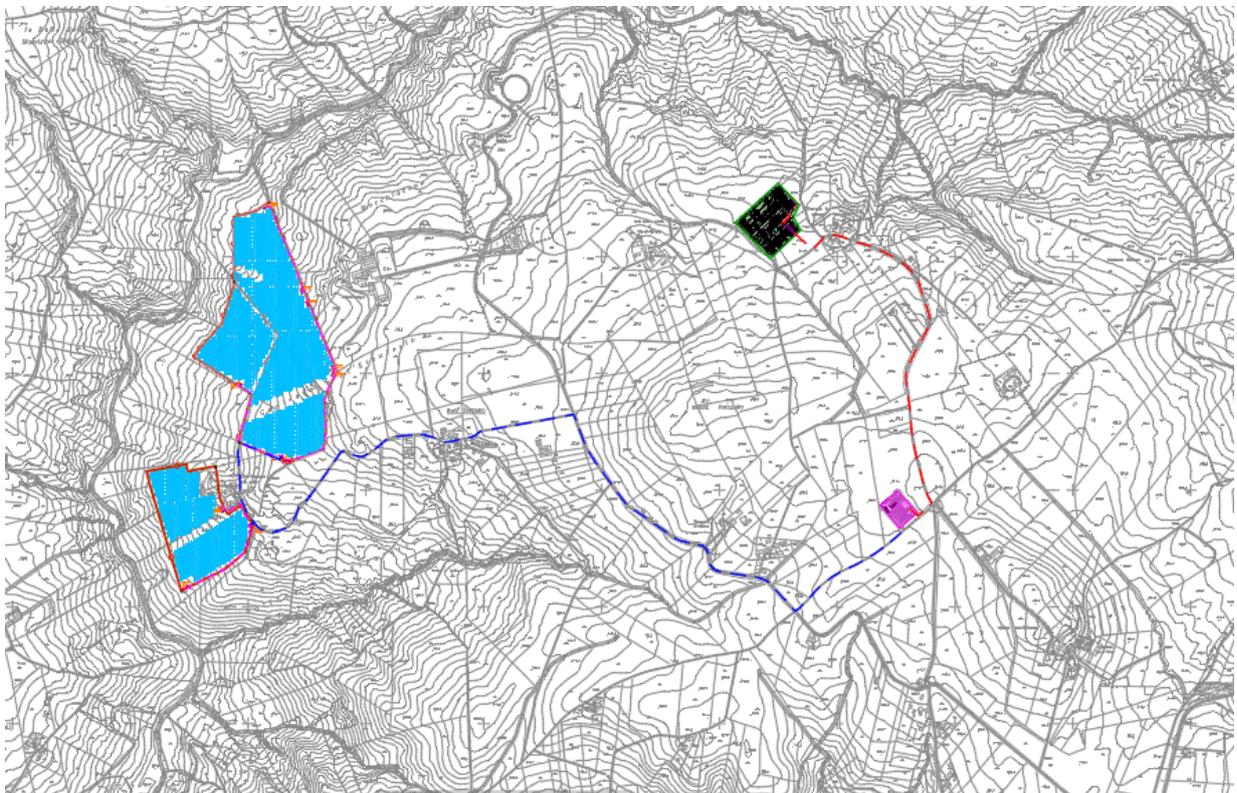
Stralcio elaborato DEF-TAV.05 – Layout su CTR
